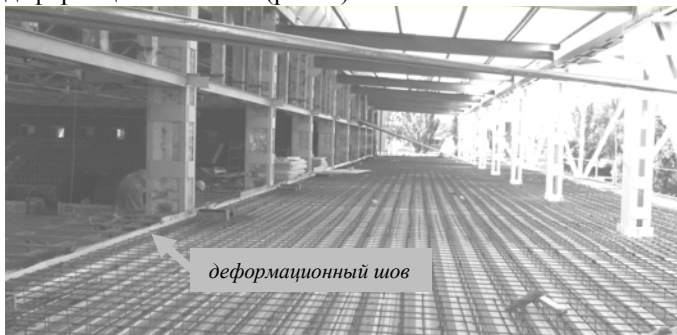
Примыкание перекрытия к существующему зданию, армирование плиты перекрытия в пристроенной части здания
